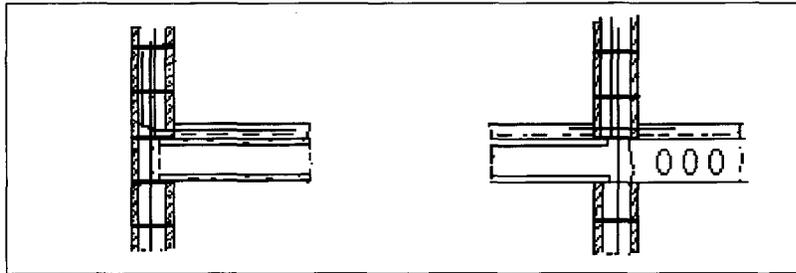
Painéis pré-tensionados vinculado por barras de aço (PARK, 1980, p. 497).
